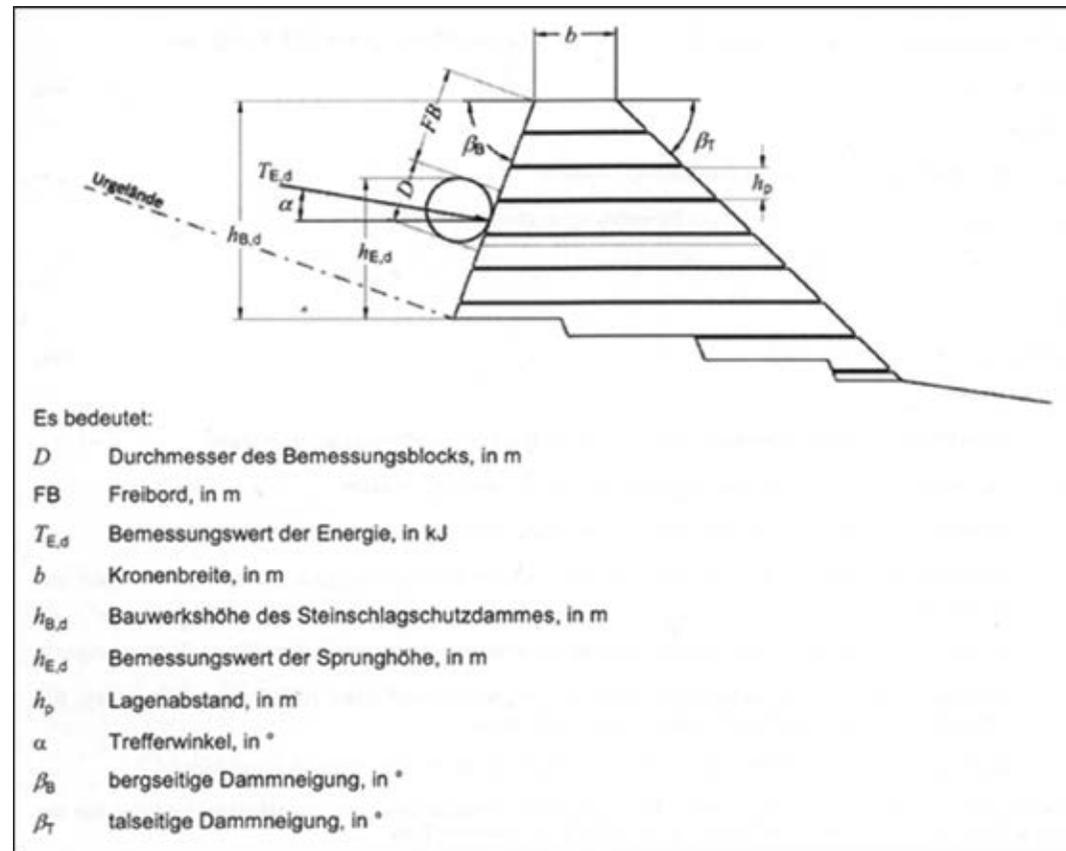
Bautyp: mit Geokunststoffen bewehrter Damm (ONR 24810)
